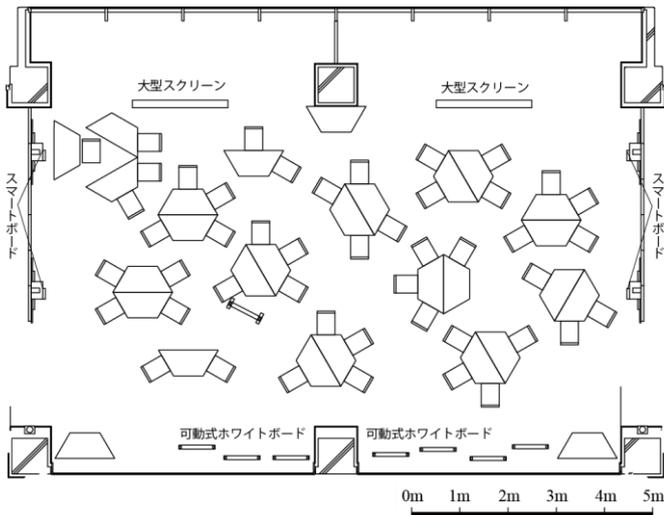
環境情報科学館 3 階 PBL 演習室：平面図
